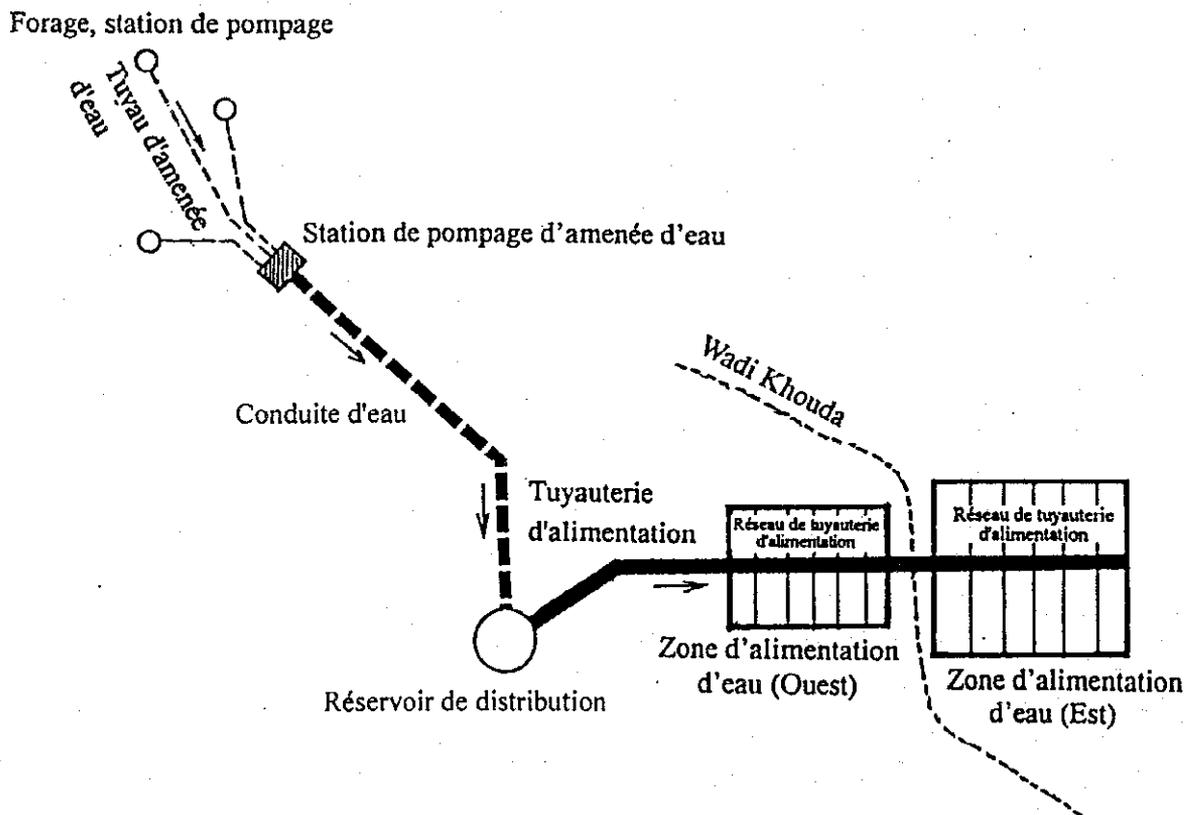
Plan de Conception du Système d'Alimentation en Eau
